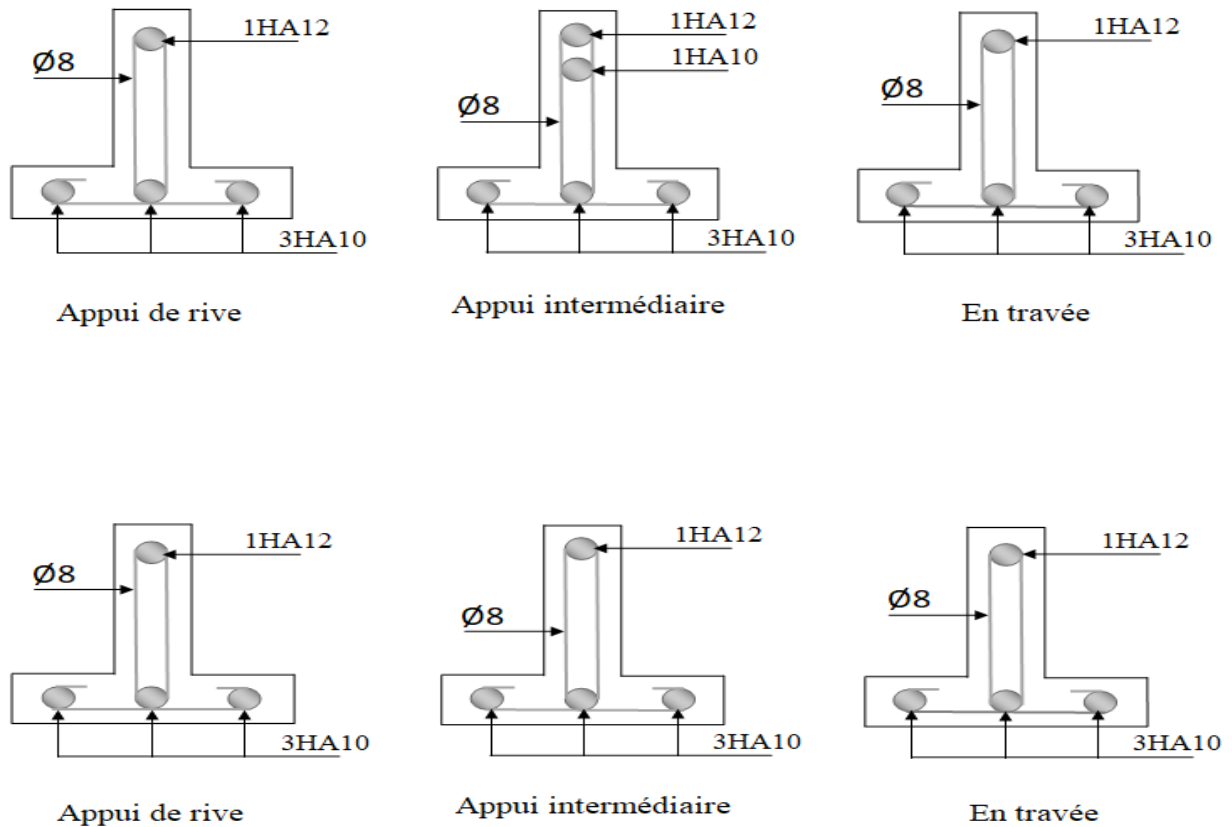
Schéma de Ferrailage des poutrelles plancher terrasse
